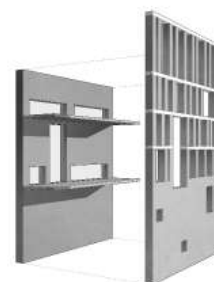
Separación de los planos de la fachada del Ayuntamiento de Murcia.
